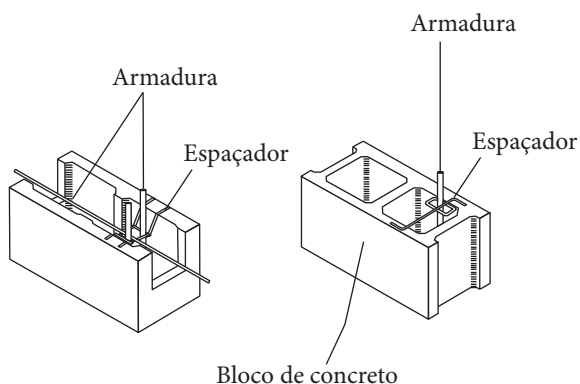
Espaçadores adequados para alvenaria estrutural (adaptada de Annotated Design and Construction Details. National Concrete Masonry Association, 2003).
